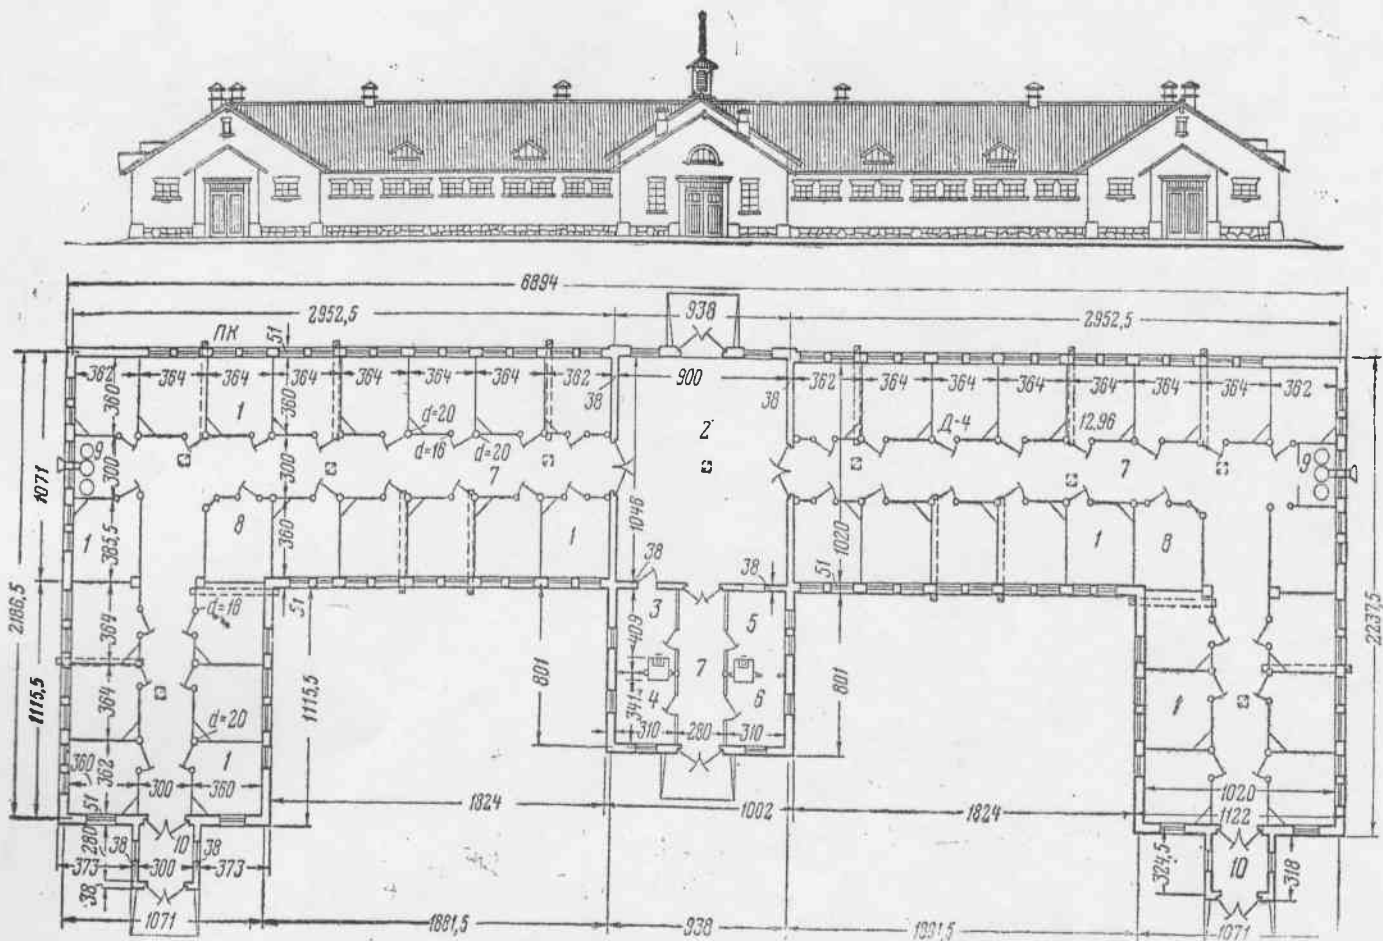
Конюшня на 40 племенных лошадей, стены кирпичные (фасад и план; размеры в см): 1—денники; 2—манеж; 3—дежурная; 4—сбруйная; 5—комната для апробации спермы; 6—инвентарная; 7—проходы; 8—фуражная; 9—площадки для воды; 10—тамбуры.
